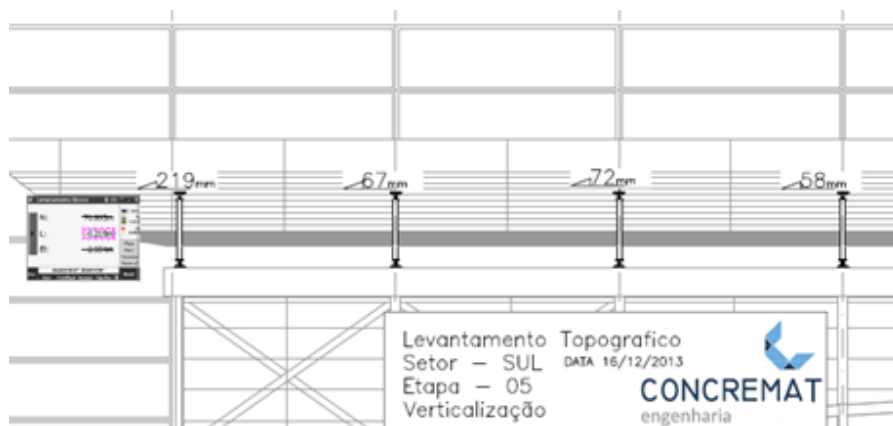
Desaprumos registrados nos pilares da cobertura Sul em 16/12/2013. Fonte: Arquivo Concremat
